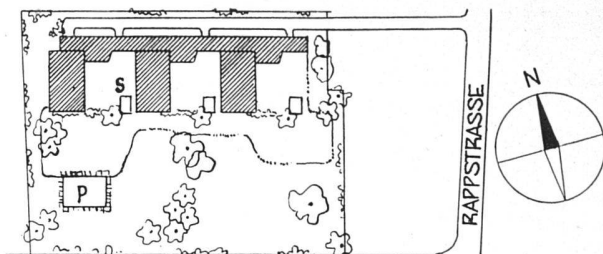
Situationsplan 1:1500 / Plan de situation / Site plan
